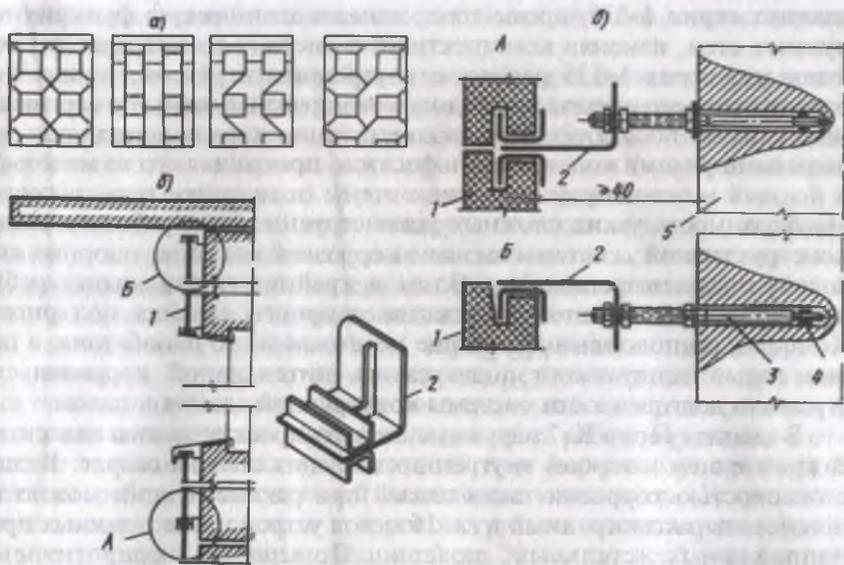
Тепло- и водоизолирующие экраны наружных стен:
